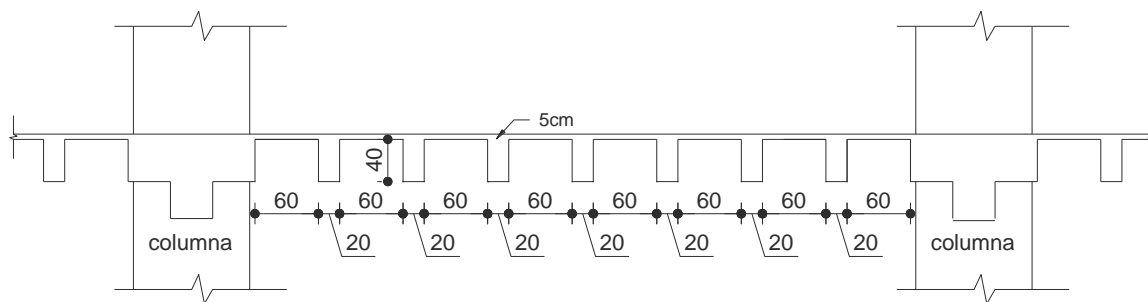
Elevación de losa aligerada, dimensiones en cm.
